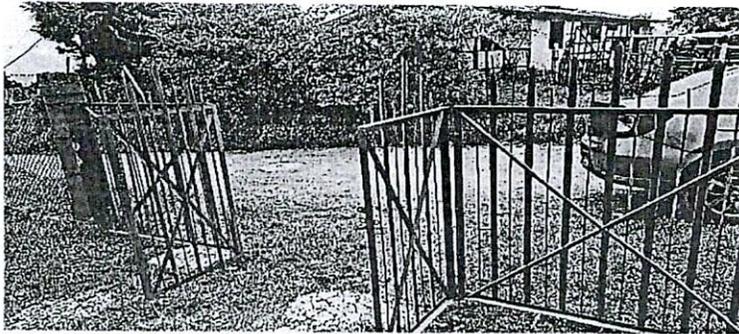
, acceso ppal a la planta, ancho 5 mts por 1,60 de alto.
